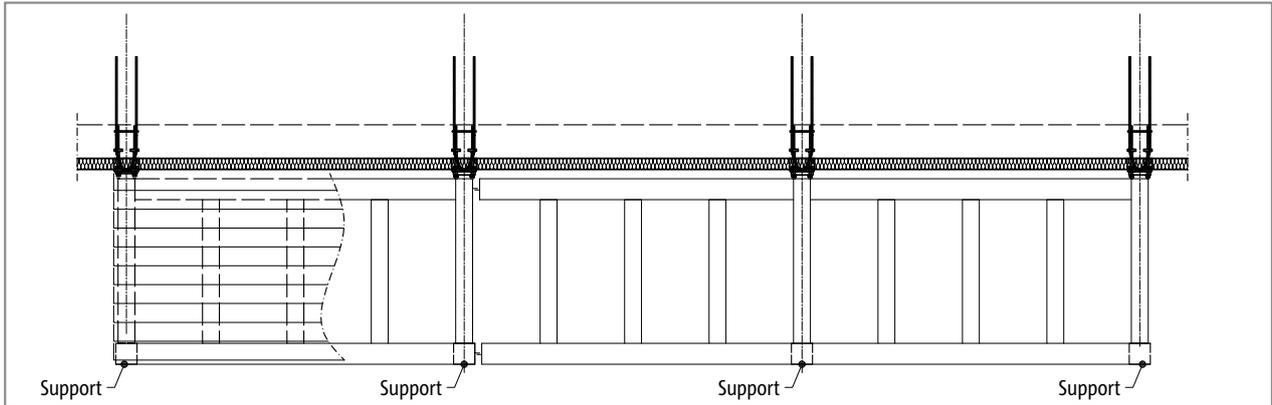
Schöck Isokorb® T type SQ : Balcon avec appuis
